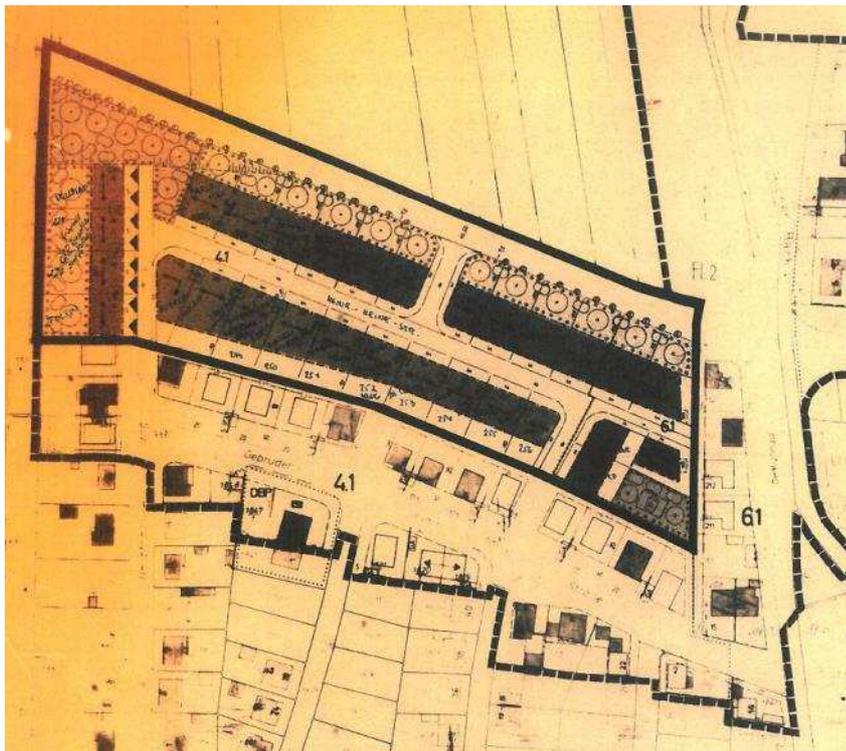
Auszug aus dem Bebauungsplan „Bruchweg-Brüchelsteg, 2. Änderungsplan“
